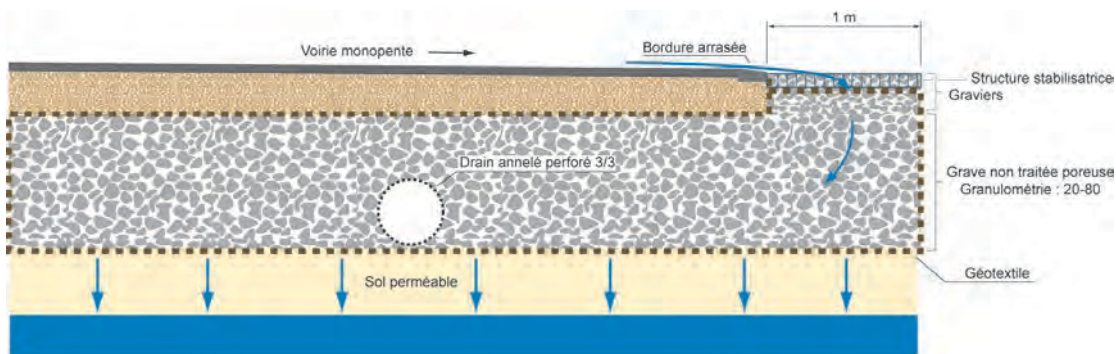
Coupe en travers voirie en mono-pente & rive drainante.
